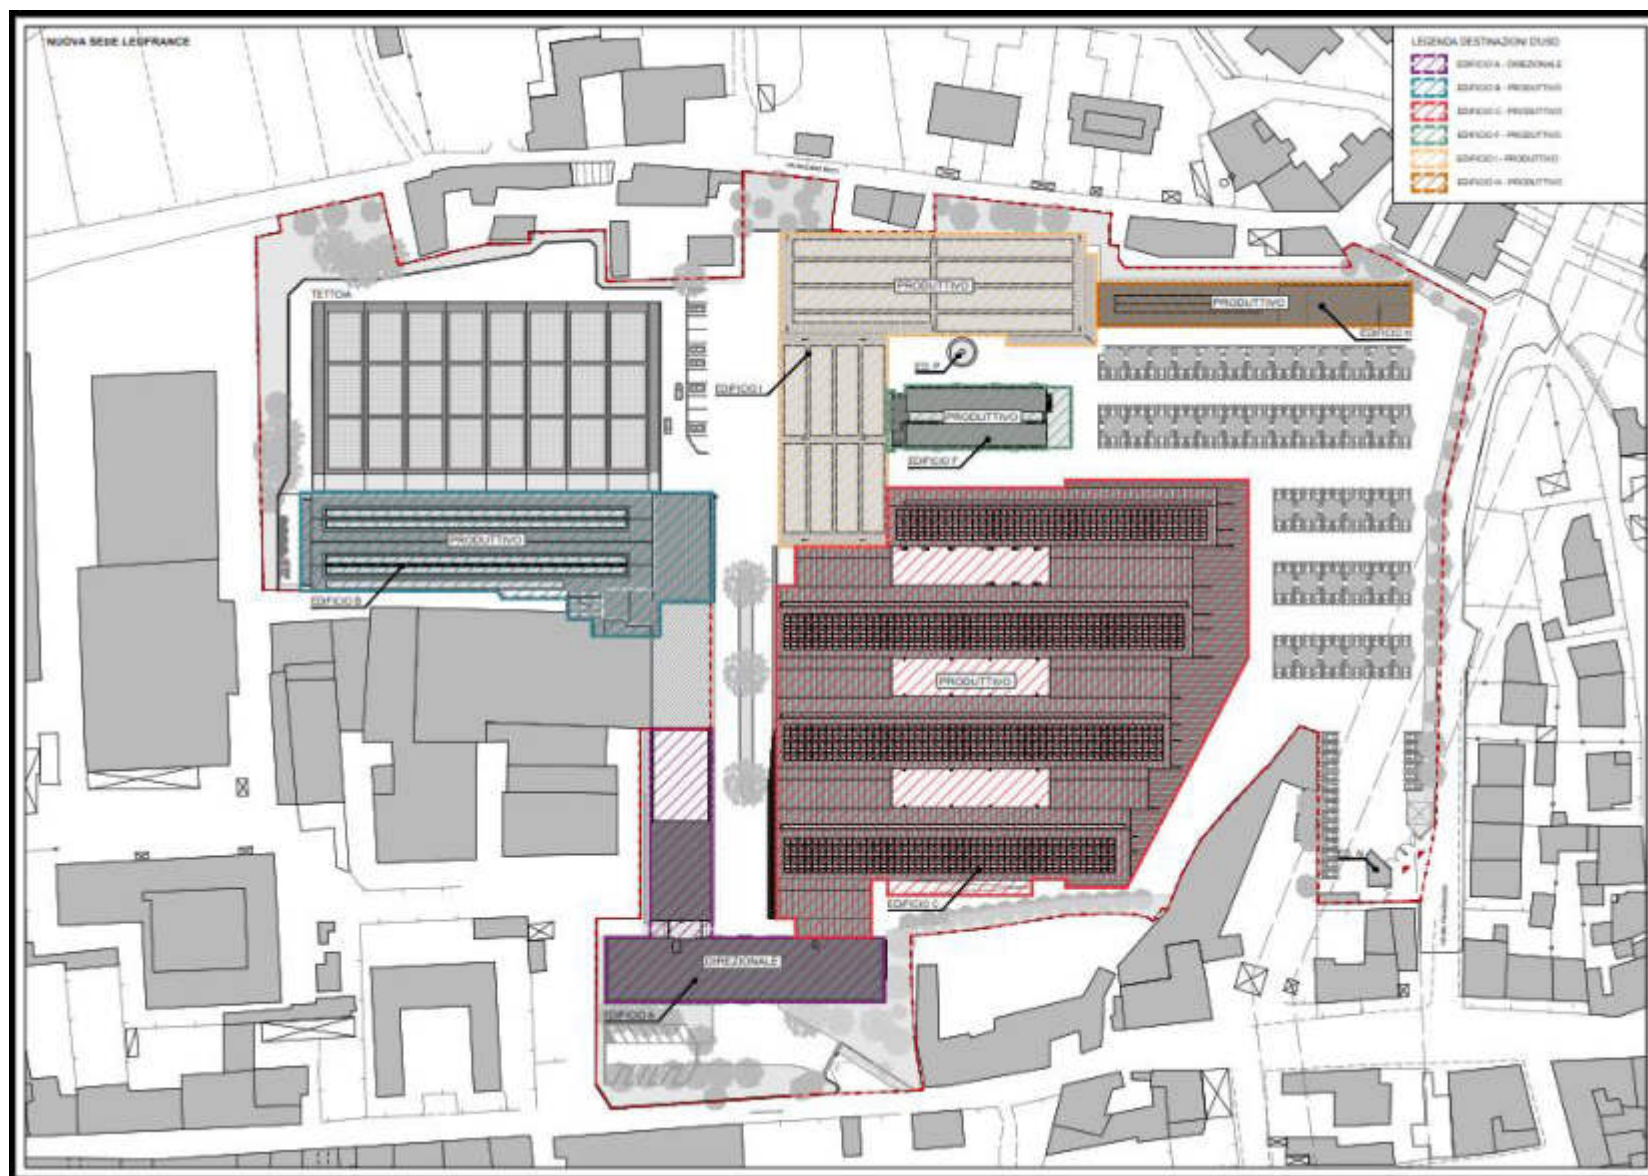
Planimetria del sito con destinazione d'uso fabbricati
